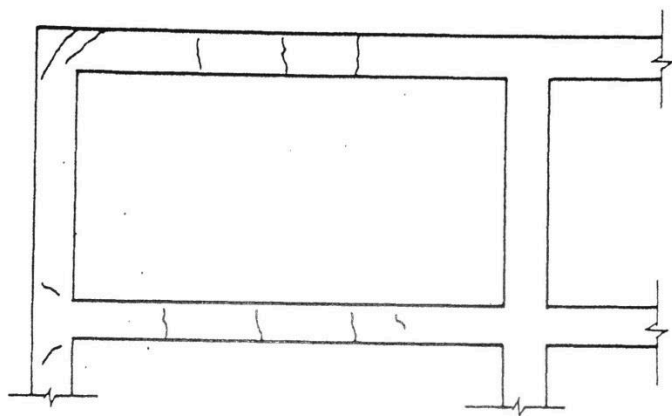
Trincas nas peças estruturais: a expansão da alvenaria solicita o concreto à tração (THOMAZ, 1989).
